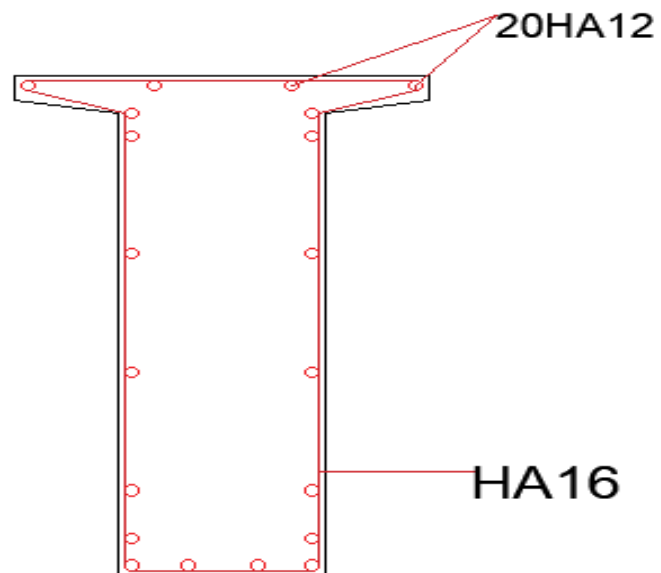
Ferrailage de la poutre (Section d'About)
